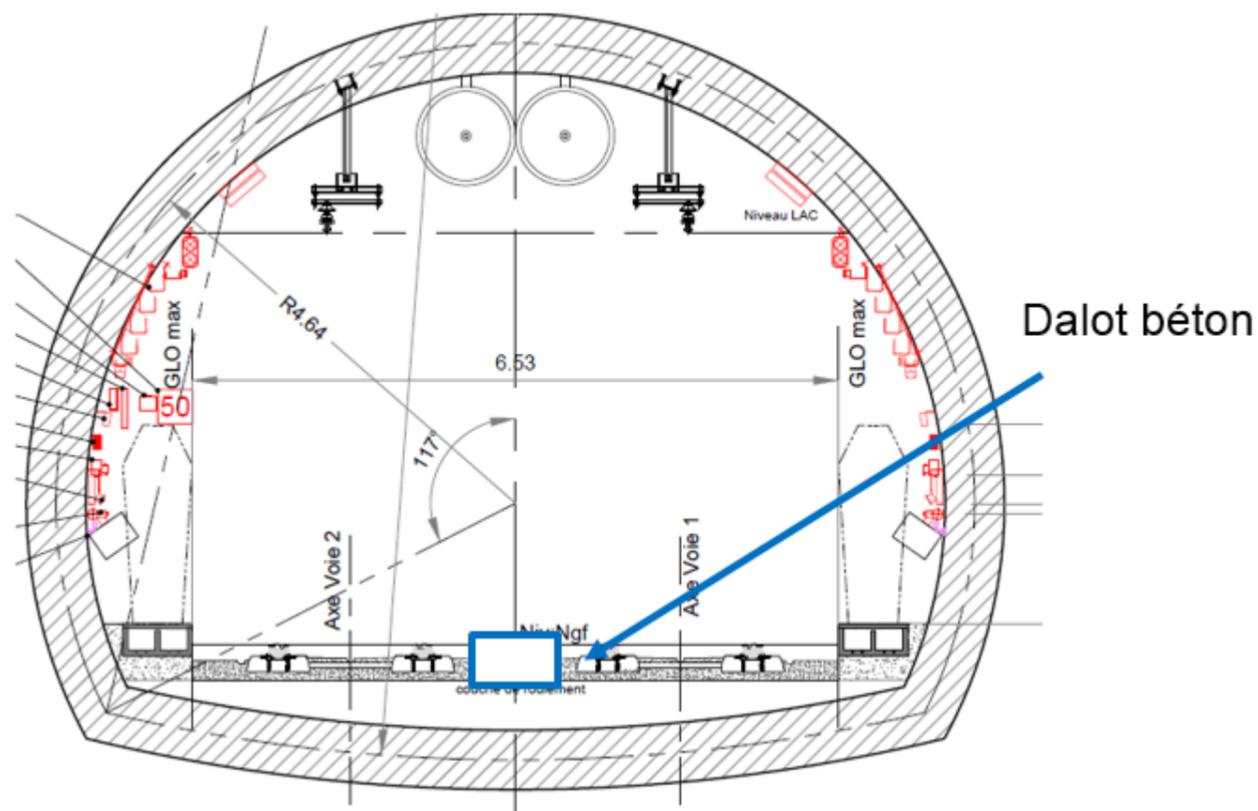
Principe de collecte des eaux dans la section en tunnel
